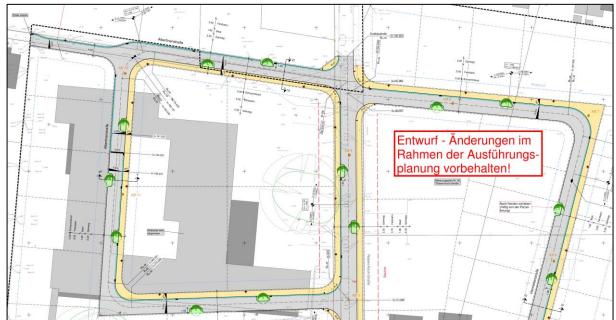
Lageplan Straßenbau Endausbau (Quelle: ibt Ingenieure + Planer Infrastruktur und Stadtentwicklung GmbH & Co. KG)
